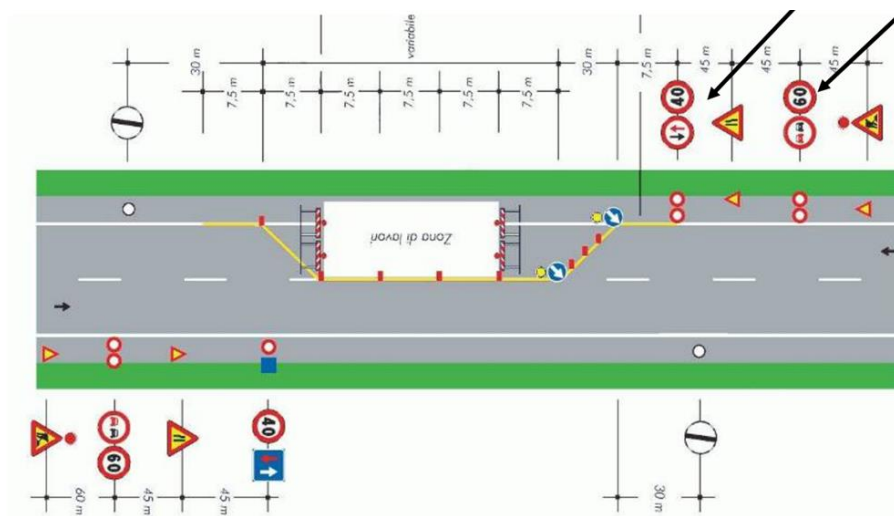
Esempio cantiere stradale con limitazione della velocità con senso unico alternato a vista.
